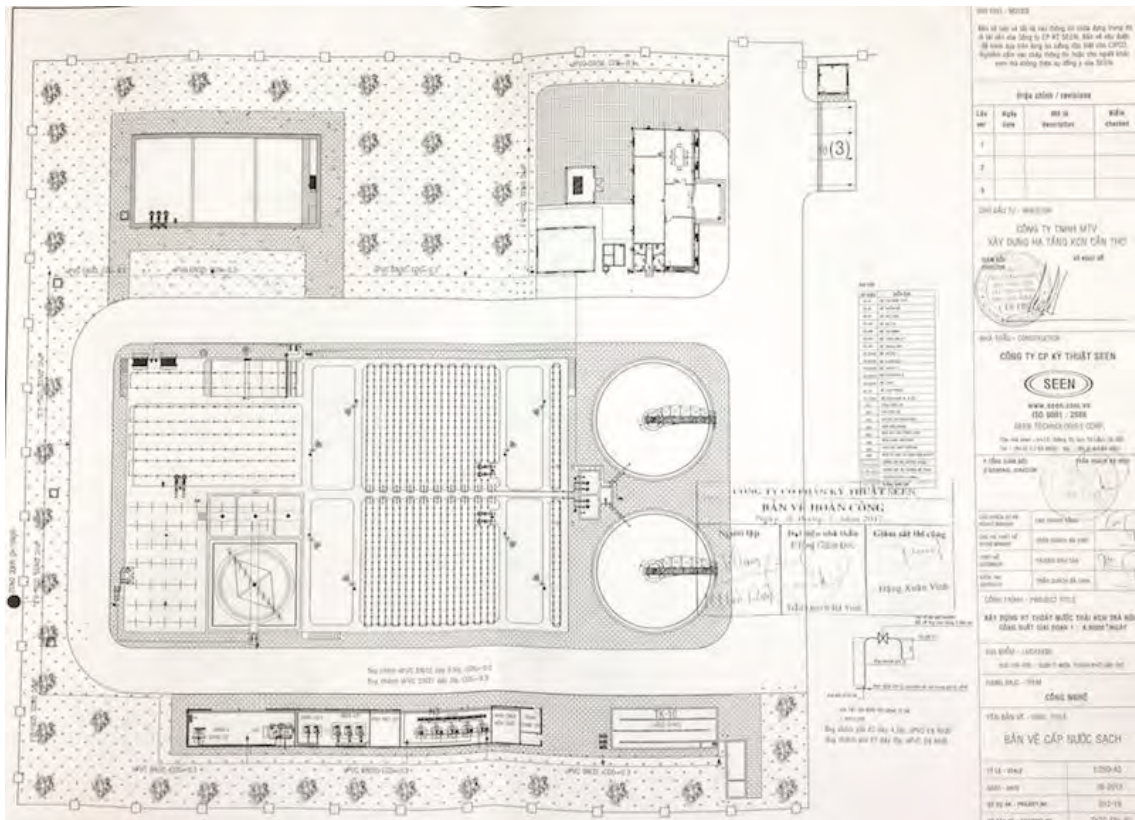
カントー市チャノック工業団地共同排水処理場の平面図
